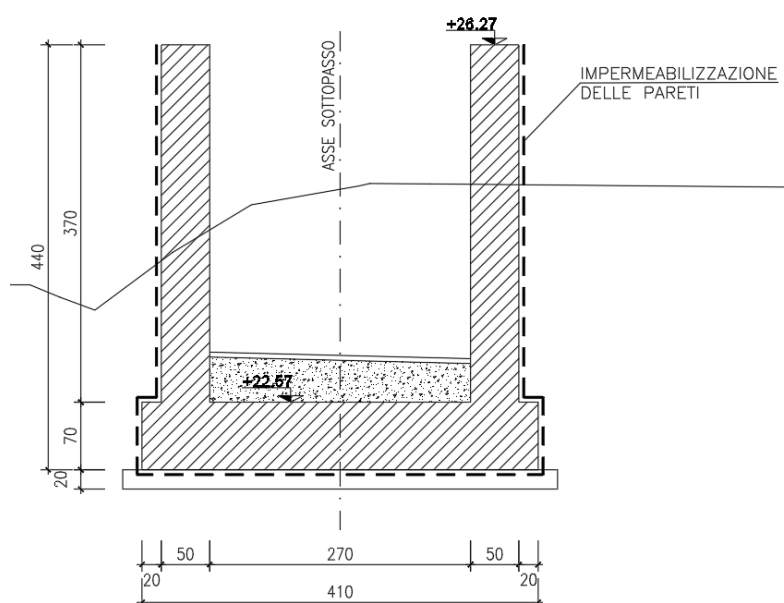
Sezione di calcolo 1 muri di imbocco SL23
